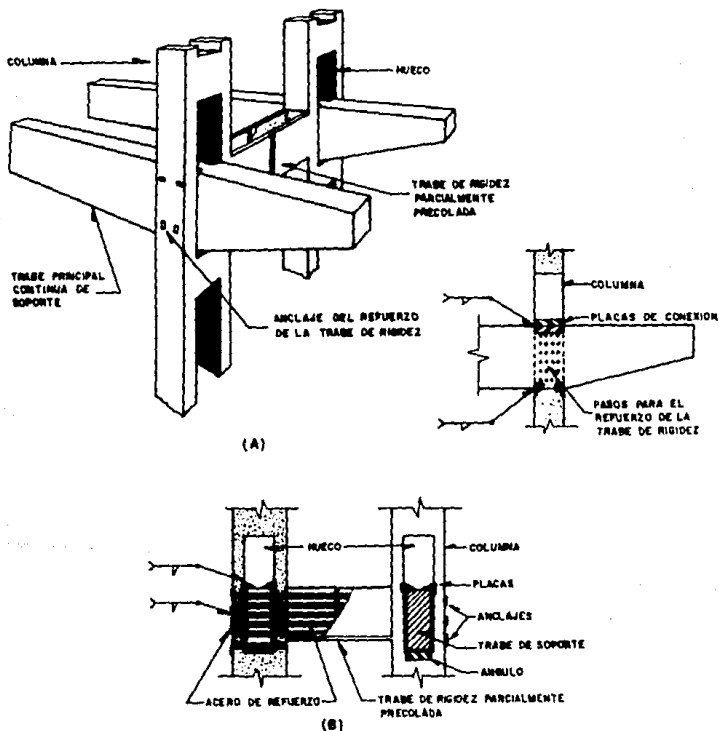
Conexión entre columna y trabe principal de soporte.
